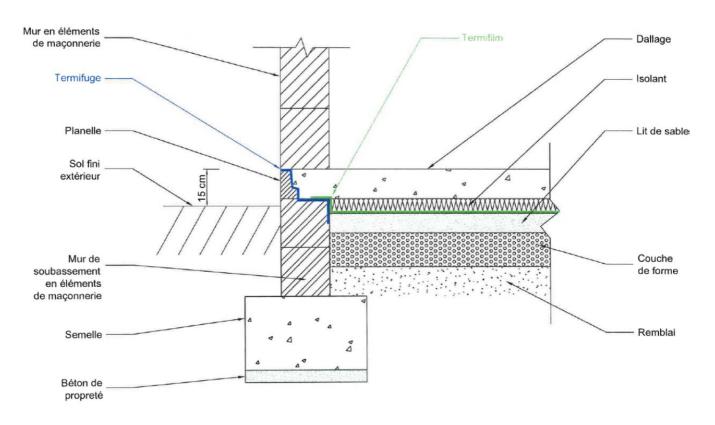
Dallage solidarisé avec planelle, soubassement maçonnerie – isolant non résistant aux termites
